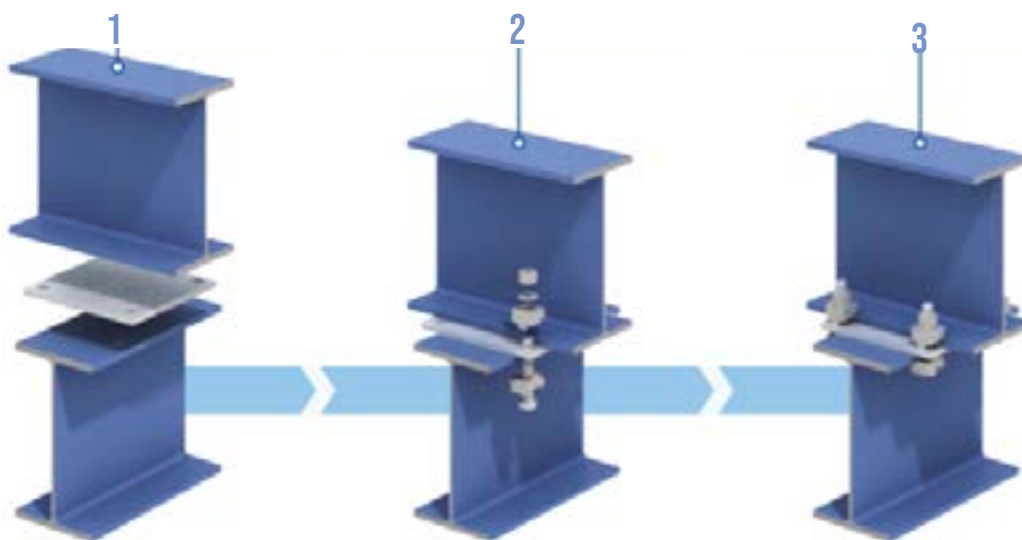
Montaje del sistema de unión diseñado por Lindapter. Fuente: Catálogo 2017 Lindapter recuperado de www.lindapter.com
